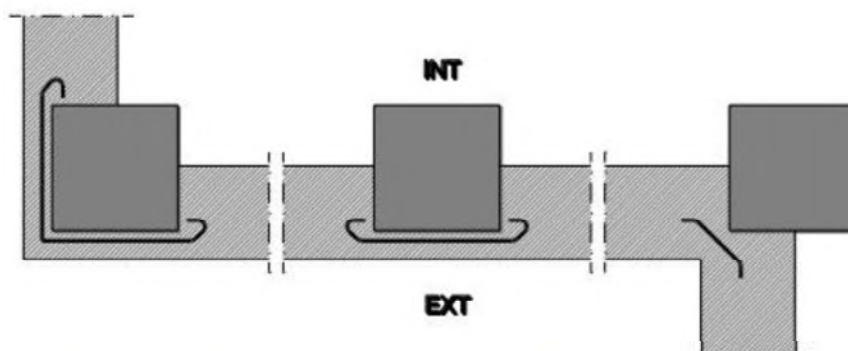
Ejemplo de encuentro de la fachada con los pilares
